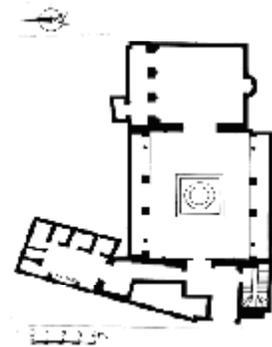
مسقط أفقي للطور الأرضي لمدرسة السبعين
